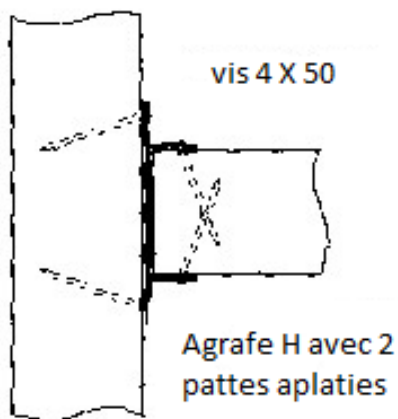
Coupe horizontale – Jonction de deux panneaux en T
